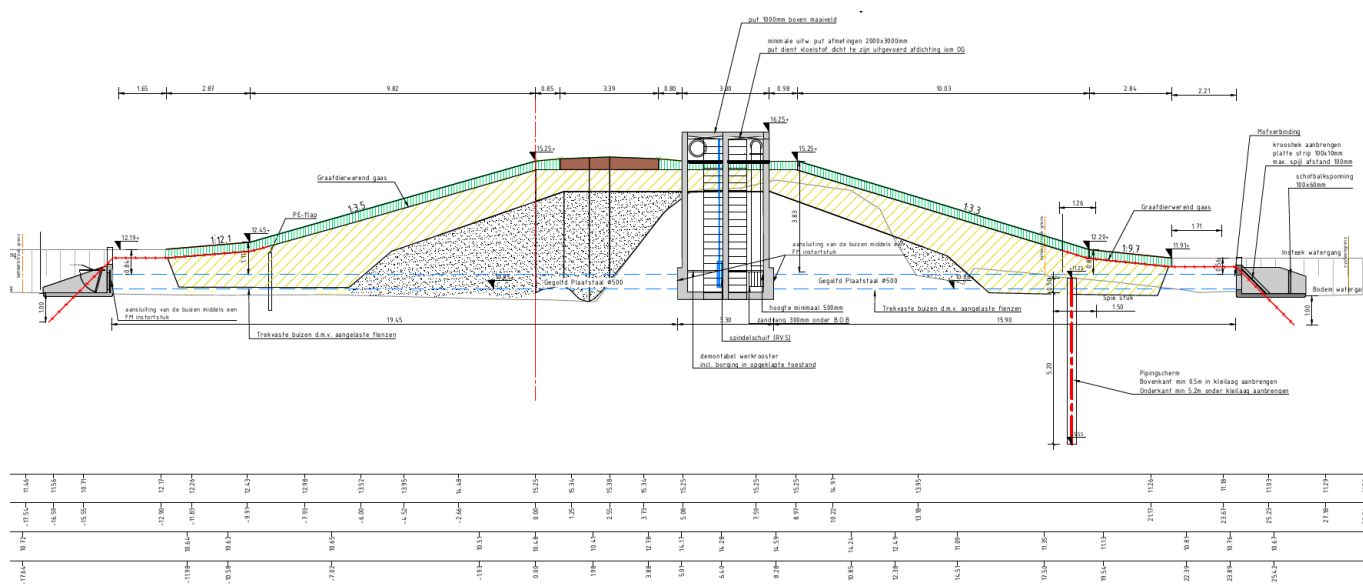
Detail doorvoer leiding Ø500 mm door damwand (OO-7)
